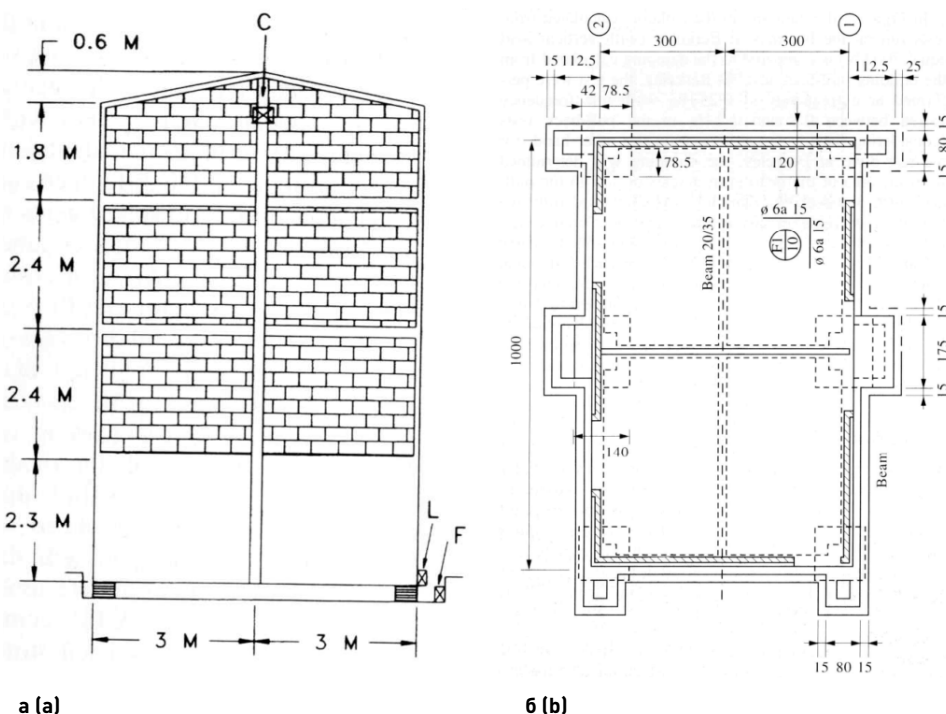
Жилое сейсмоизолированное здание в Андалусии: а – поперечный разрез; б – габариты в плане [2]
